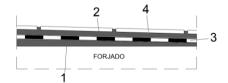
Detalle constructivo cubierta con encuentro de paramento vertical.
